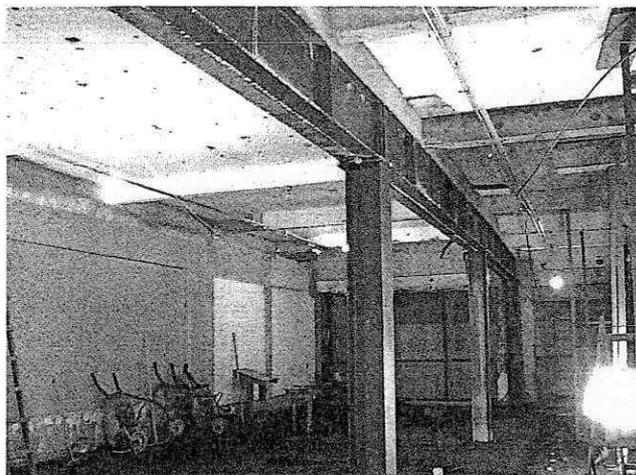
Viga Metálica que substituiu a antiga estrutura.
